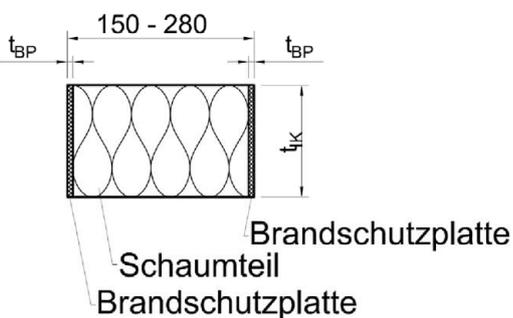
Schöck Isokorb® CXT Typ A Part Z für Attiken und Brüstungen
